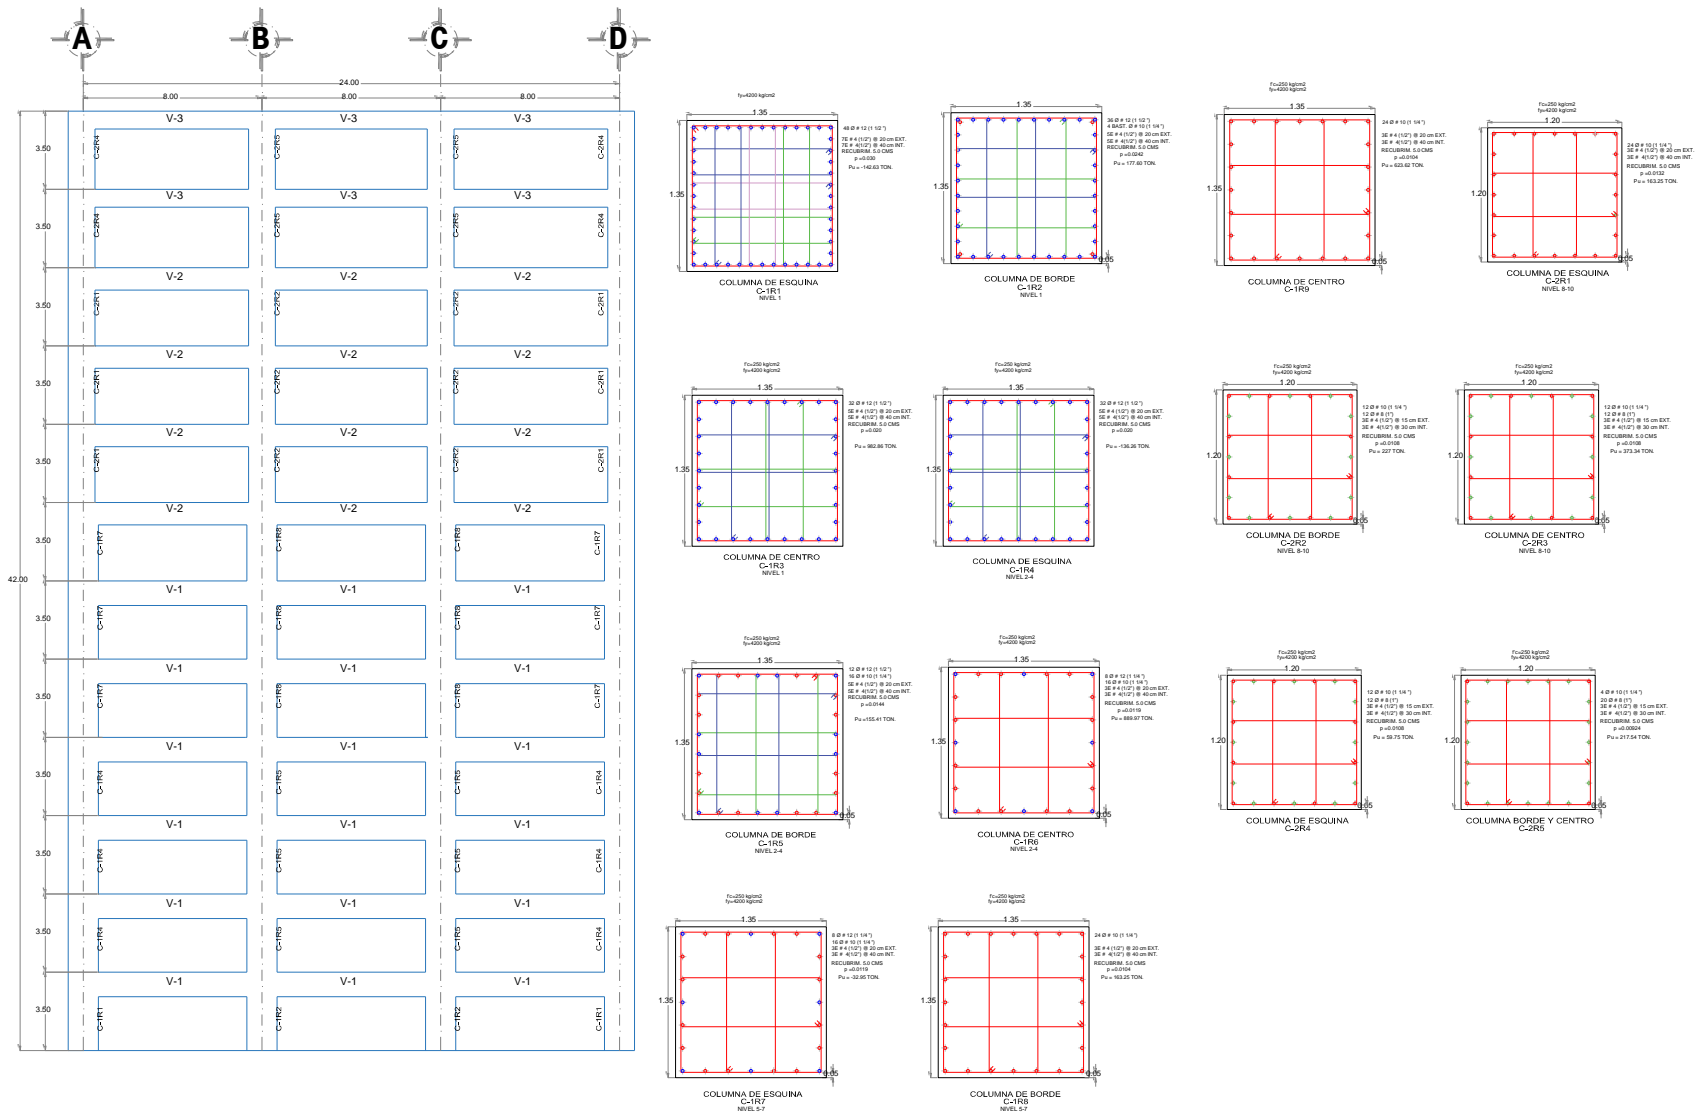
Detallado de armado de columnas de edificio de 12 niveles con base a la hipótesis de las NTCC-04.
